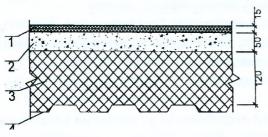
Конструкция совмещенного покрытия здания производственного назначения:
